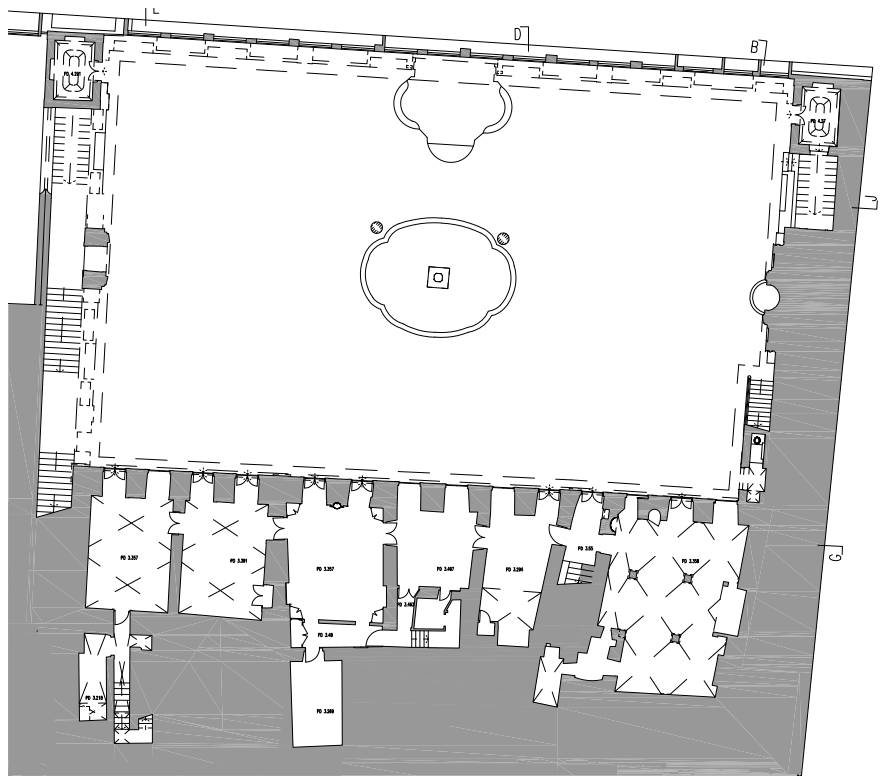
Planta do piso 1 (piso nobre) do Palácio Pombal
